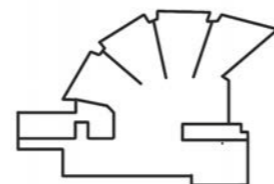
Planta esquemática da biblioteca Mount Angel Abbey.
